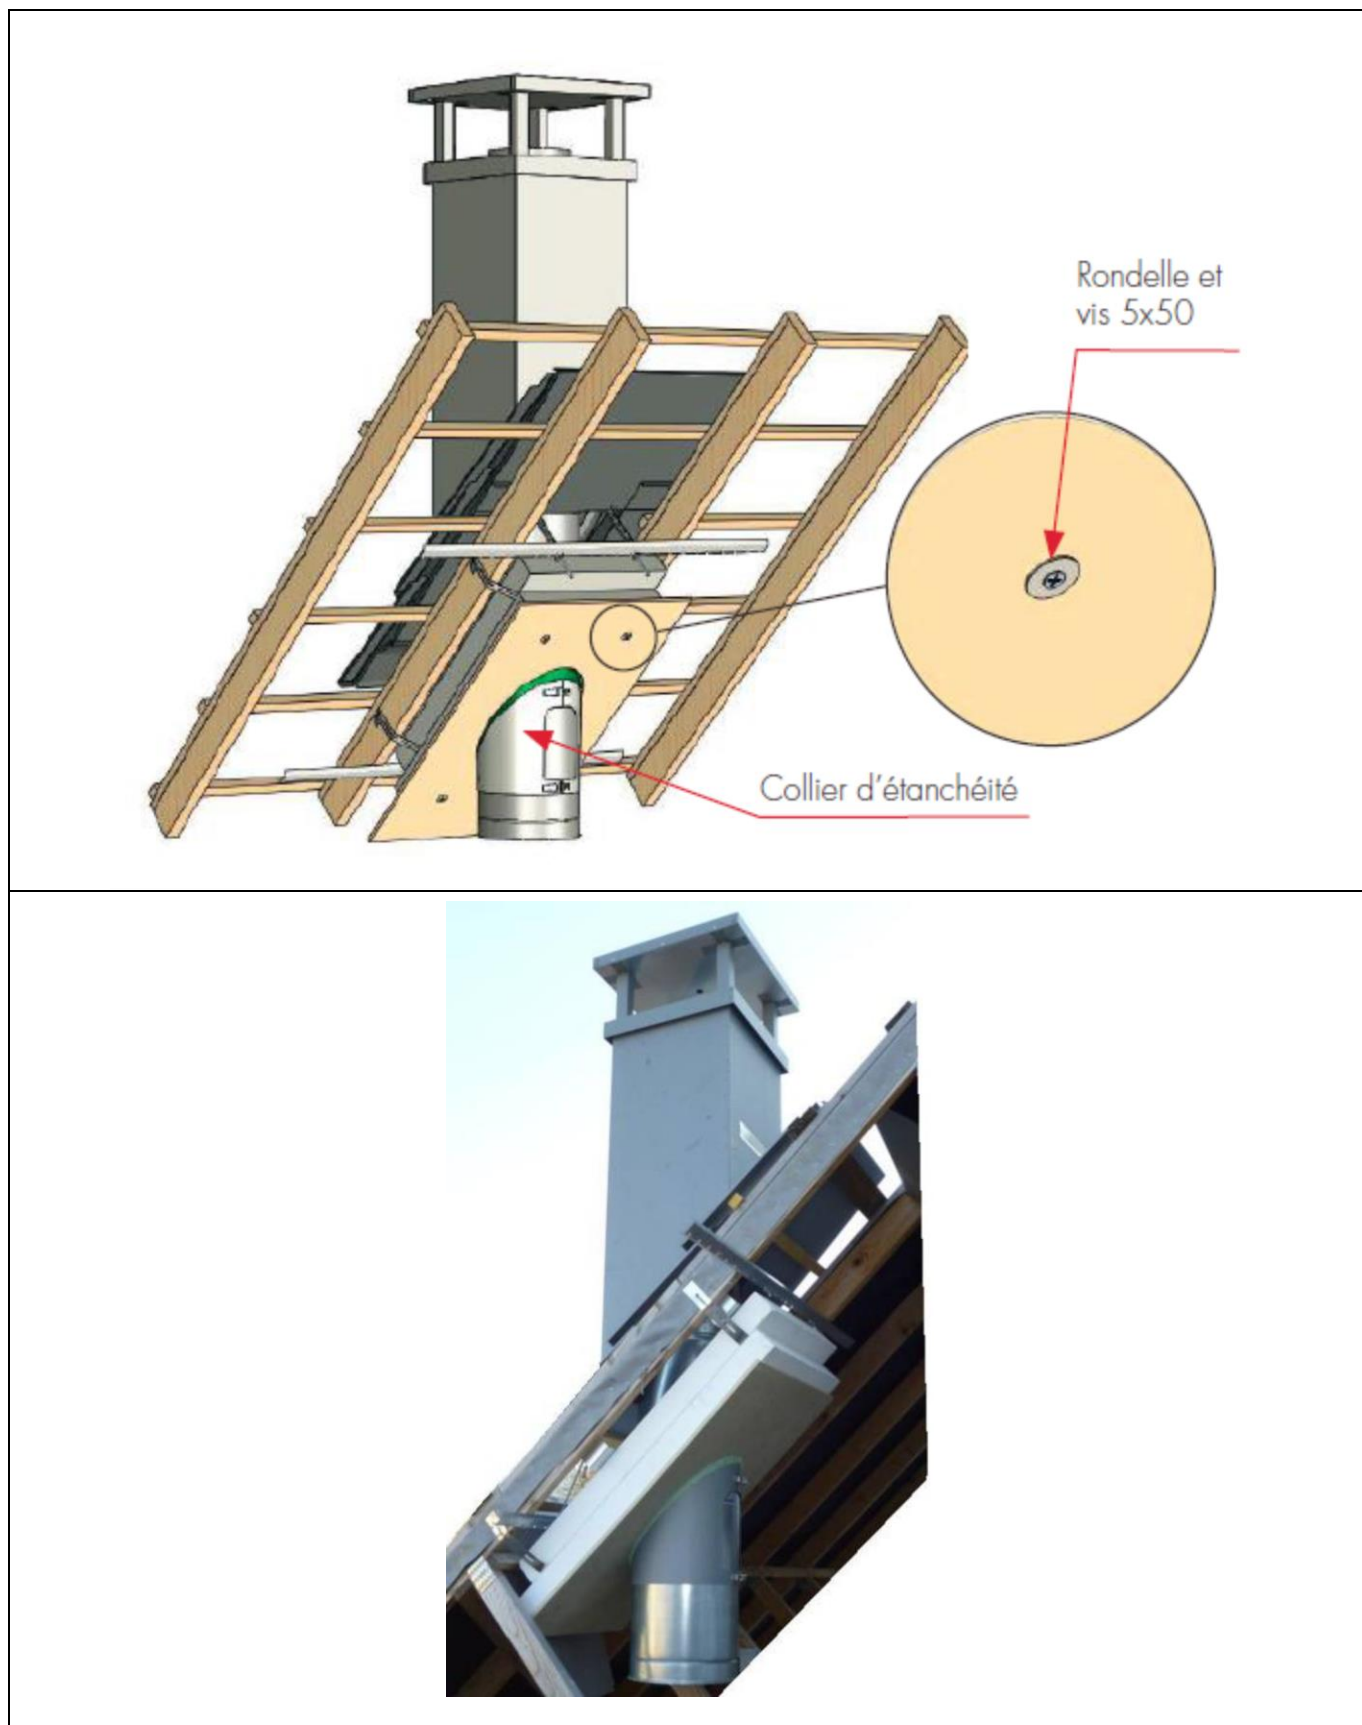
Schéma de mise en œuvre en traversée de plancher (maison de plain-pied, plafond rampant)
